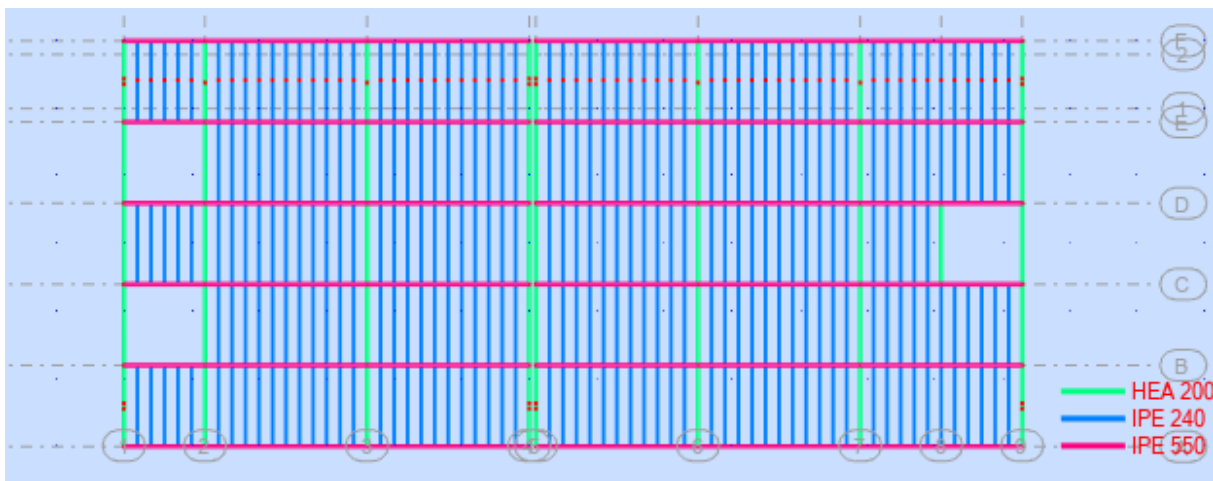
Vue en plan du plancher niveau : 8.84 m
